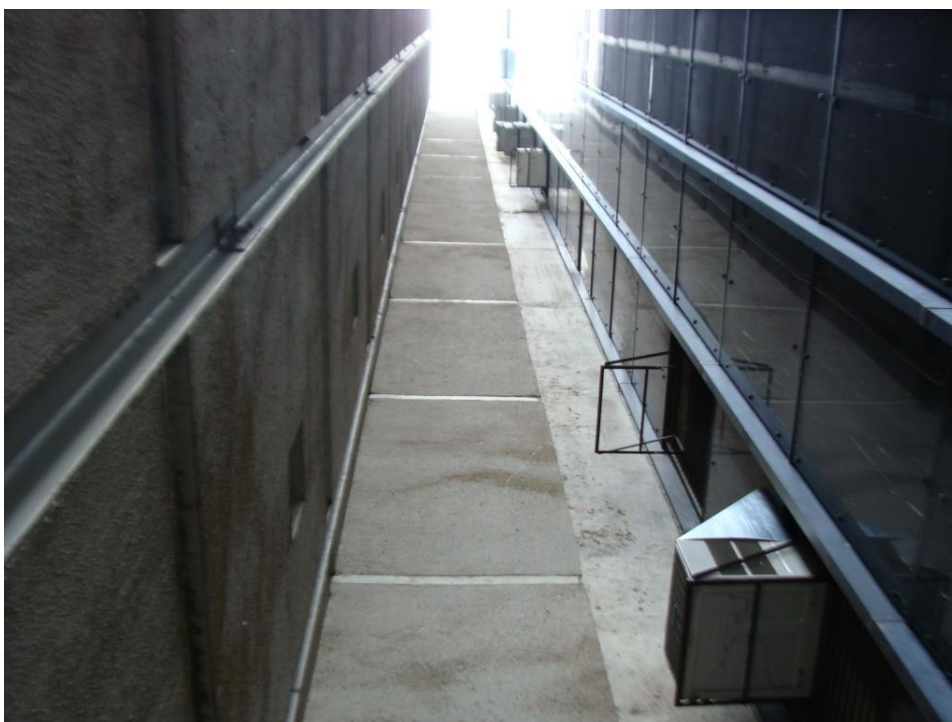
Situação Parede de concreto Lado esquerdo (02/03/2021)
